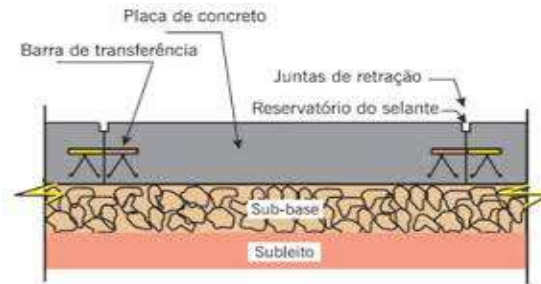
Detalhes da composição das camadas da pavimentação rígida (Fonte: Moretto, 2020).
